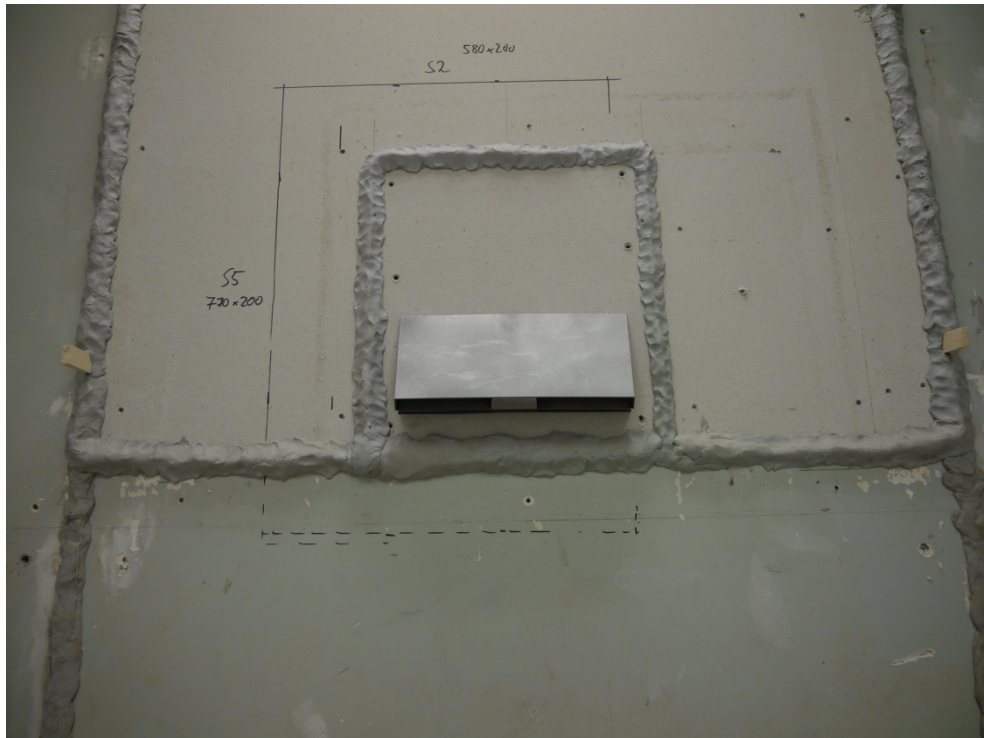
Lüftungsöffnungen außenseitig mit fertig montiertem Fassadenabschluss Edelstahlschote (Ansicht Senderraum prüffertig).
